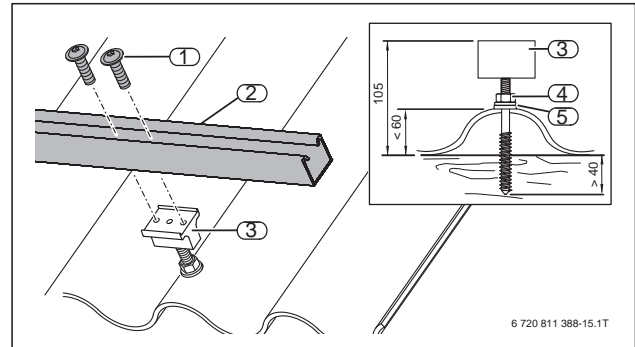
Beispiel für die Befestigung der Profilschienen bei der Aufdachmontage auf einer Wellplatten-Eindeckung (Maße in mm)
